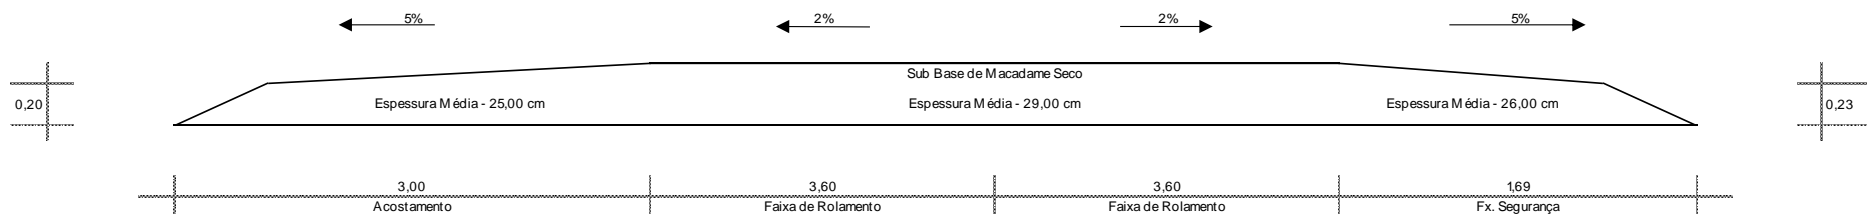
Seção Transversal Tipo de Pavimentação – Pista Principal – Tipo 4
